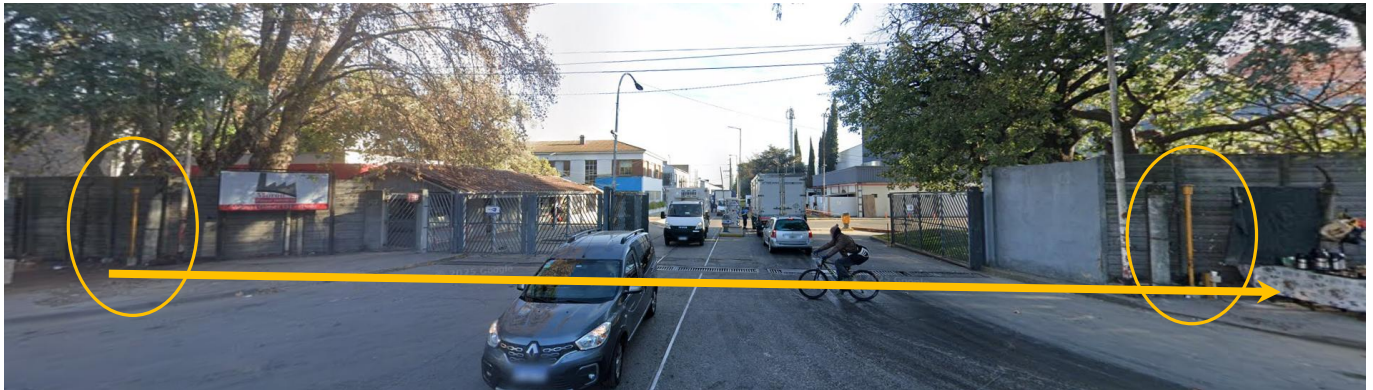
Vista en detalle del acceso a Parque Industrial Morón, desde la calle Valentín Gómez y señalización de la infraestructura de gas natural existente. También se verifica el portón de acceso restringido y paredón que delimita el sector industrial de la vía pública.
